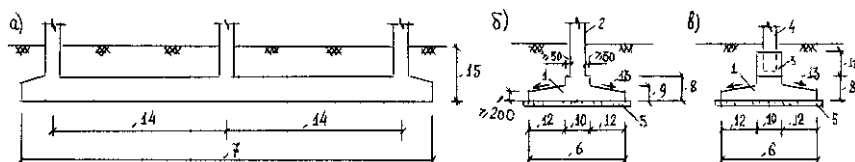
Конструктивные элементы ленточного фундамента под ряды колонн: а – продольный разрез, б – опирание монолитной колонны, в – опирание сборной колонны
